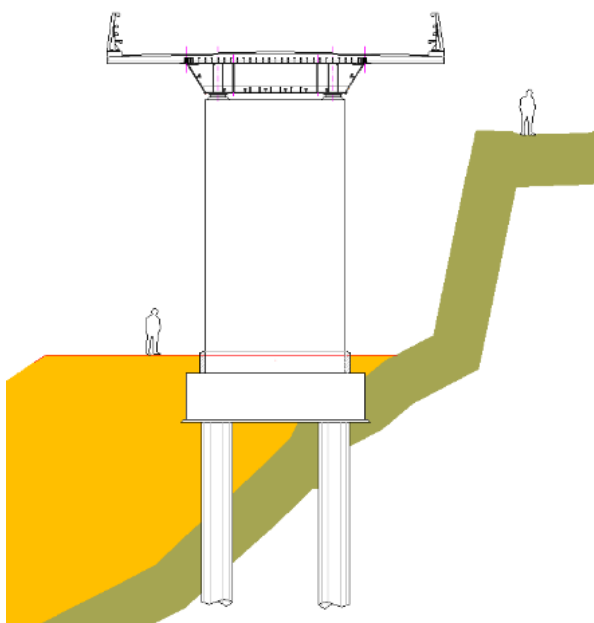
Sección viaducto, pila y cimentación pilotada a media ladera.
